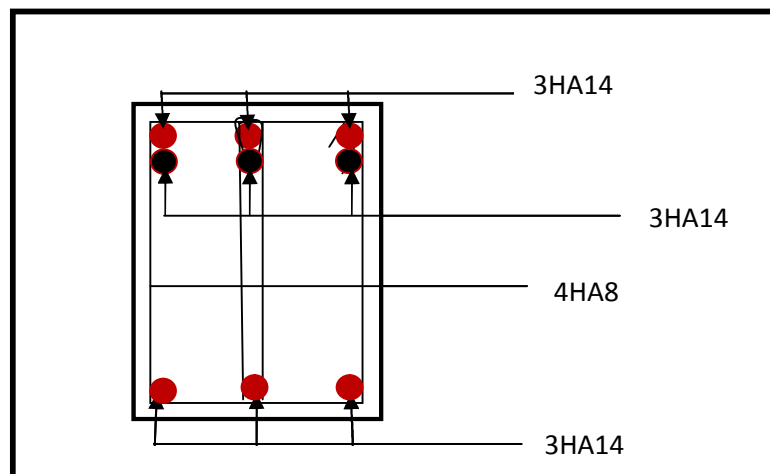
Figure.VI : Ferrailage sur appuis d'une poutre secondaire
